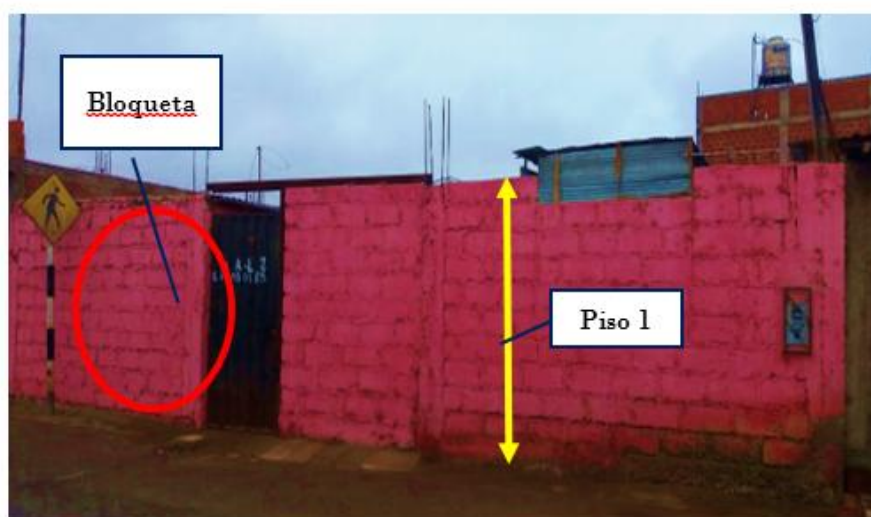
Vista de vivienda 15. Vivienda construida con la unidad de albañilería Bloqueta de 1 pisos y diafragma flexible.
